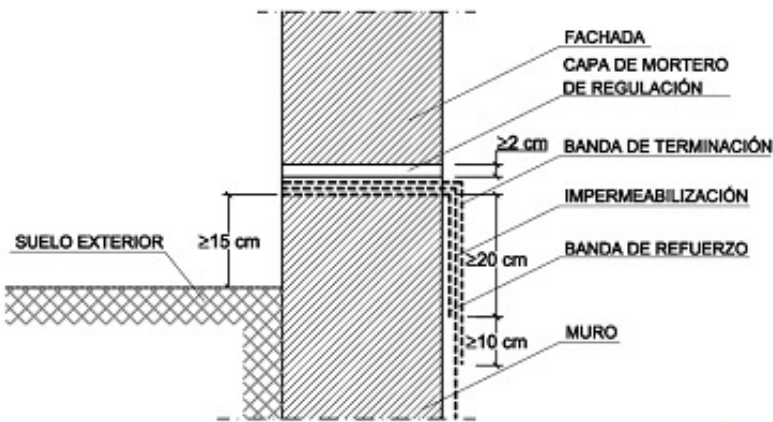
Ejemplo de encuentro de un muro impermeabilizado por el interior con lámina con una fachada
